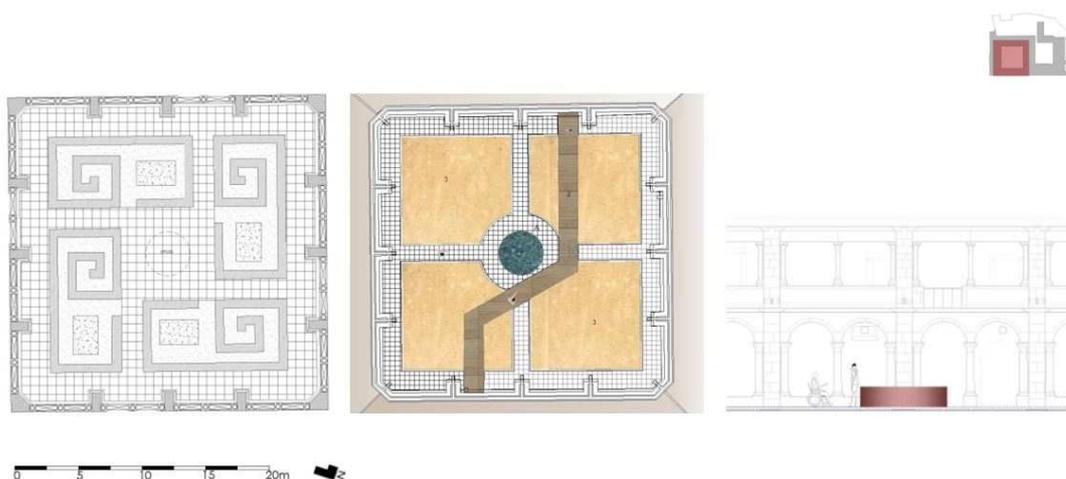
Imagem da planta existente e da planta e corte transversal, vista do poço com o rebordo (gargalo) elevado.
